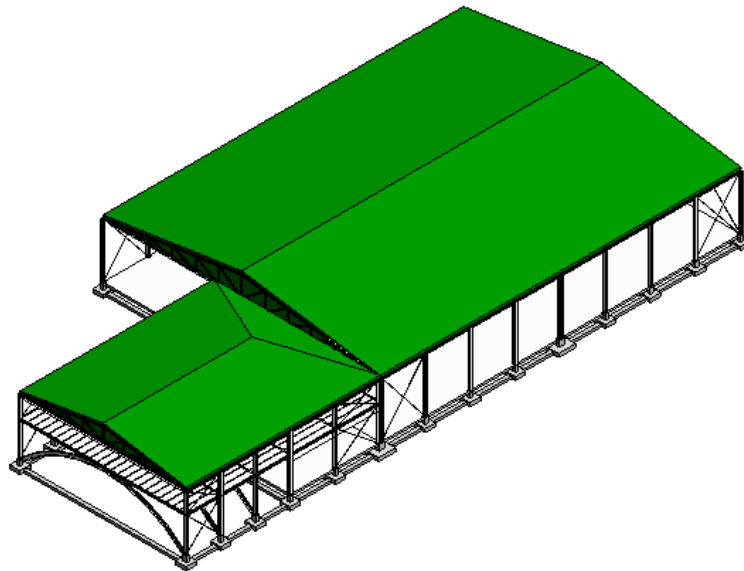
Resultado del paso de plantilla estructural a plantilla arquitectónica.
